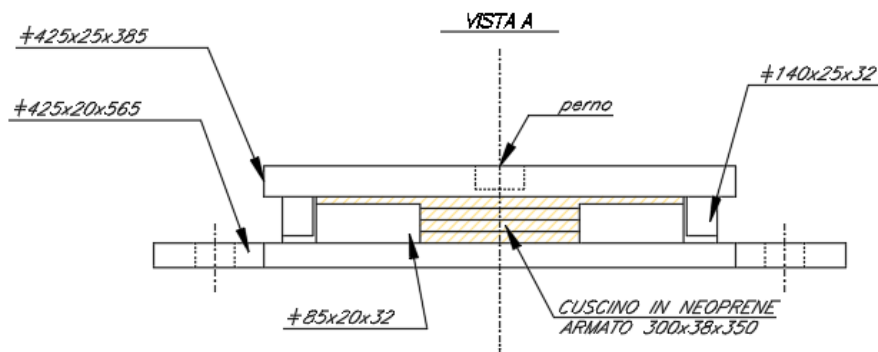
Dispositivi di appoggio fisso – Sezione longitudinale
